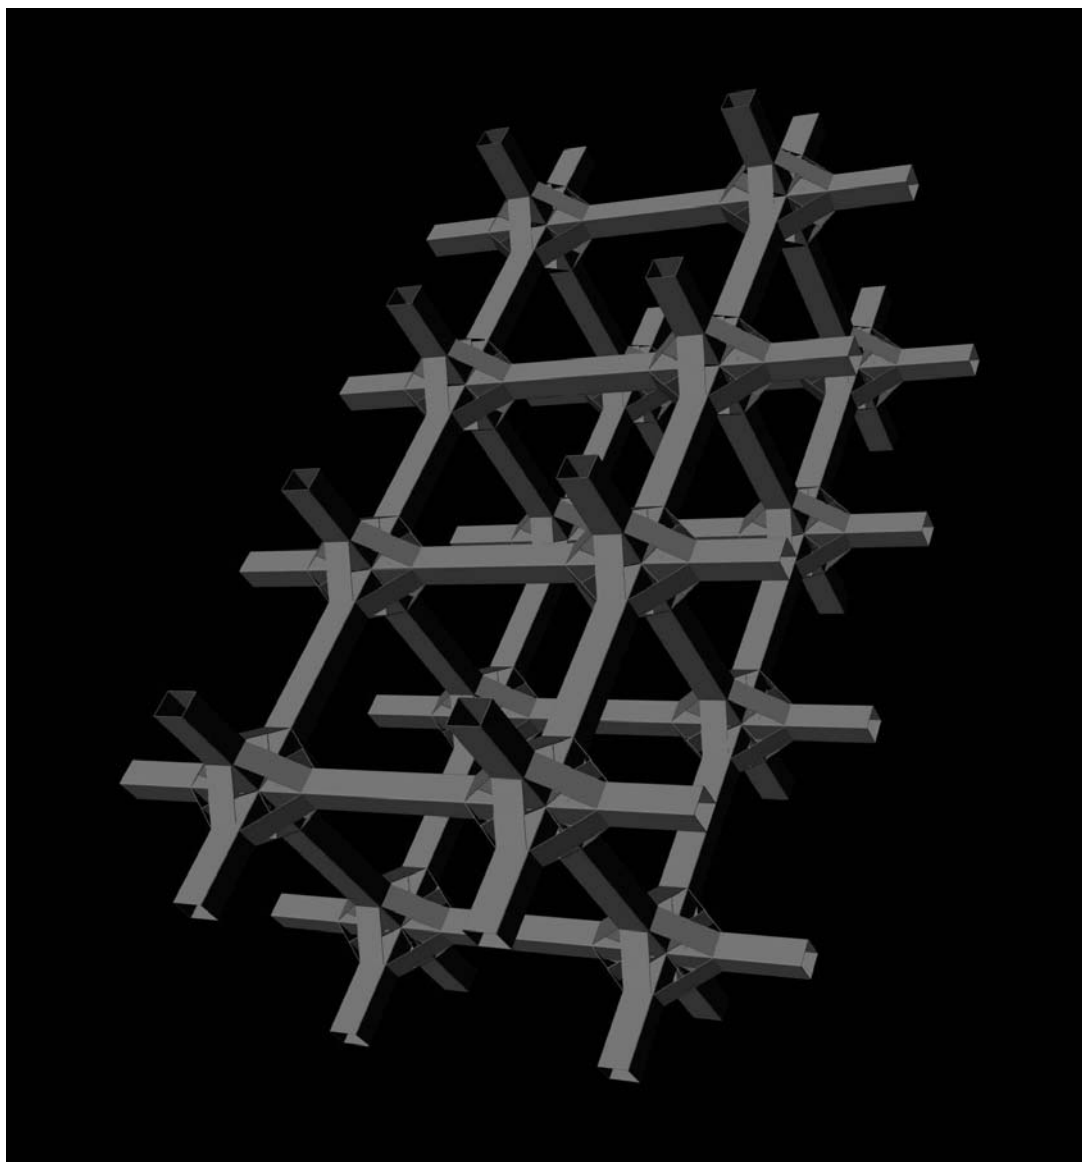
Фрагмент пространственного каркаса из перекрестных трубчатых (трубобетонных) элементов с вутами в общем виде.
